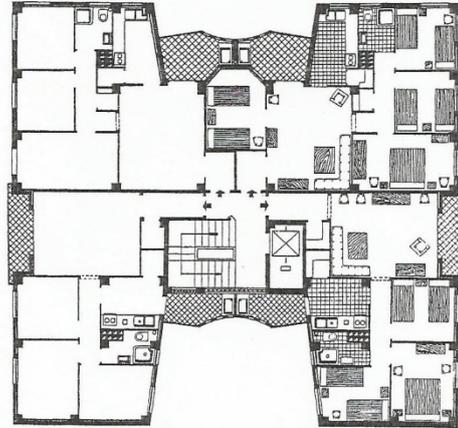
Plano de distribución extraído de "Hogar y Arquitectura"
